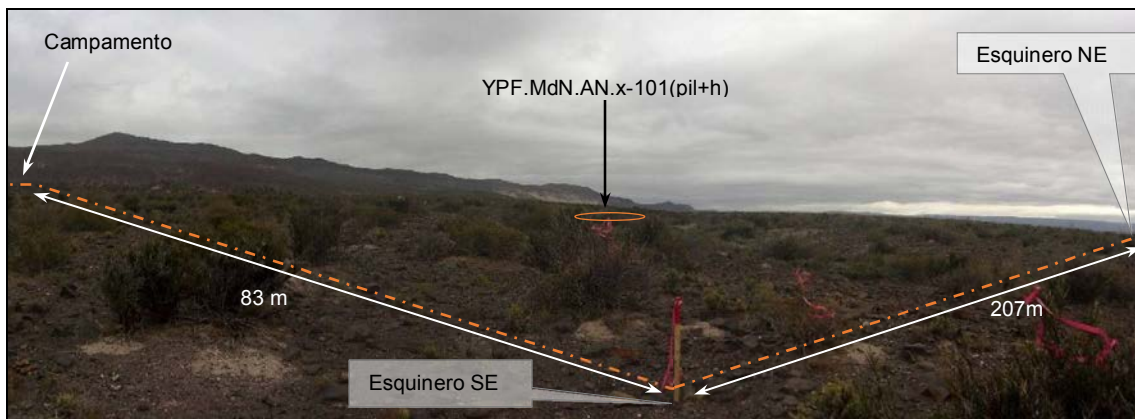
Vista panorámica en dirección Noroeste, desde el esquinero Sureste de la futura locación. Se grafica aproximadamente el perímetro de la locación. En este sector se puede denotar un relieve levemente irregular con pendiente hacia el Sureste.
